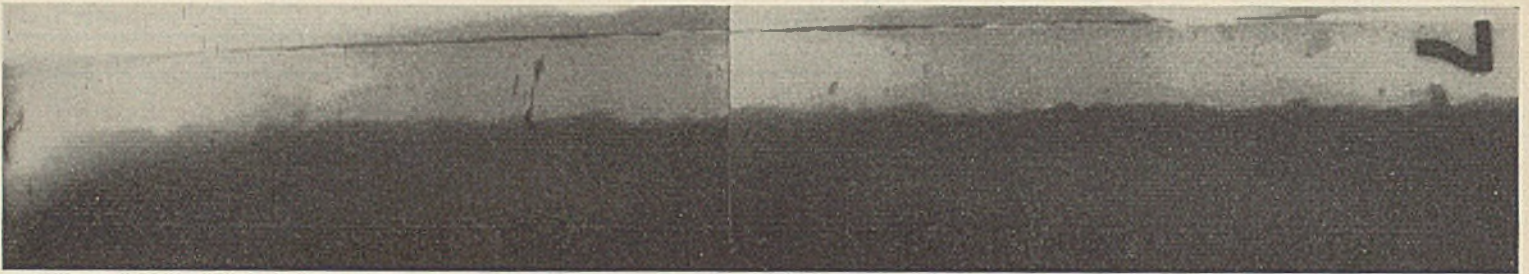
Baustellen-Röntgenaufnahme der Kehlnaht am Stehblechstoß (16—17 des Hauptträgers II).
